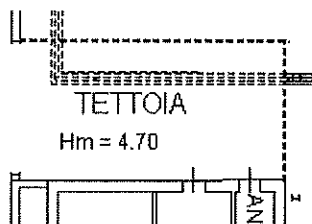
Estratto planimetria depositata presso l'archivio catastale
